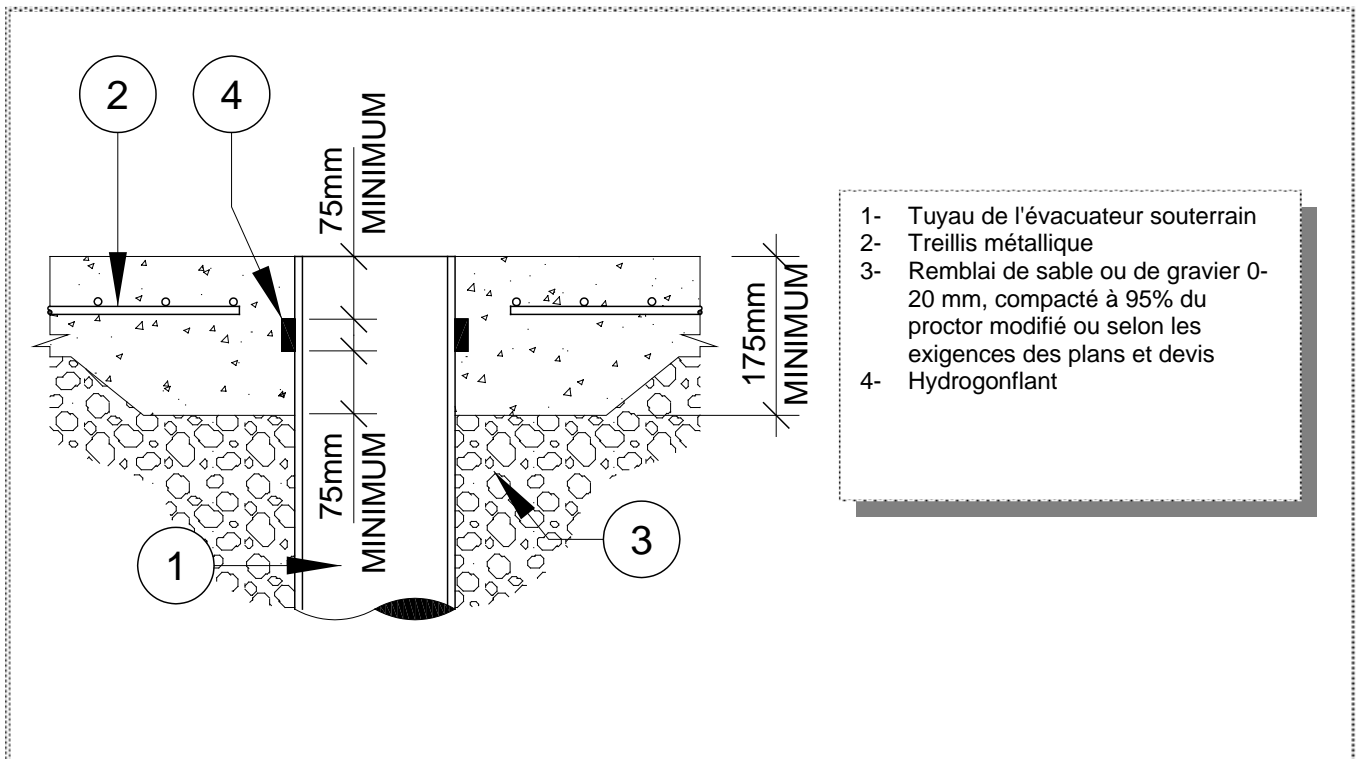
Étanchéité entre une sortie d'évacuateur souterrain et la dalle (Joint de construction) (Source : Waterstop - RX)
